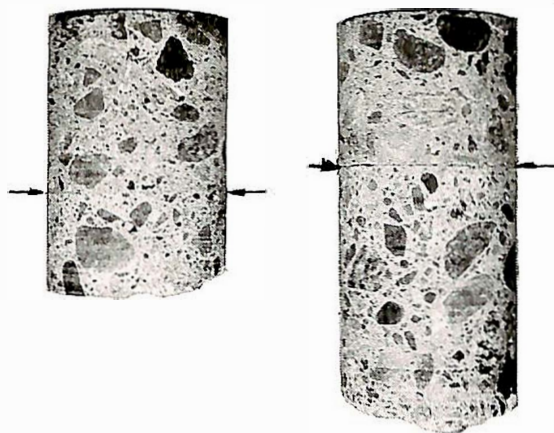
Borrkärnor, uttagna ur betongbeläggning som försetts med nytt slitlager av betong. Den horisontella fogen markerad med pilar.
